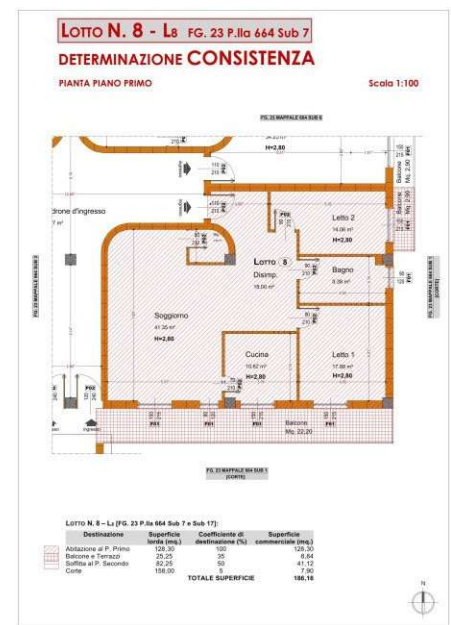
Determinazione consistenza Lotto L8 (ALL. 11).
